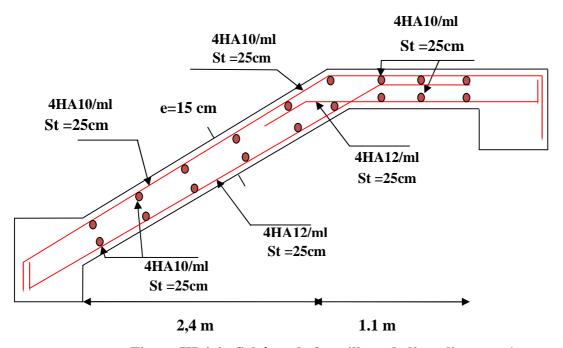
Schéma de ferraillage de l'escalier type 1
